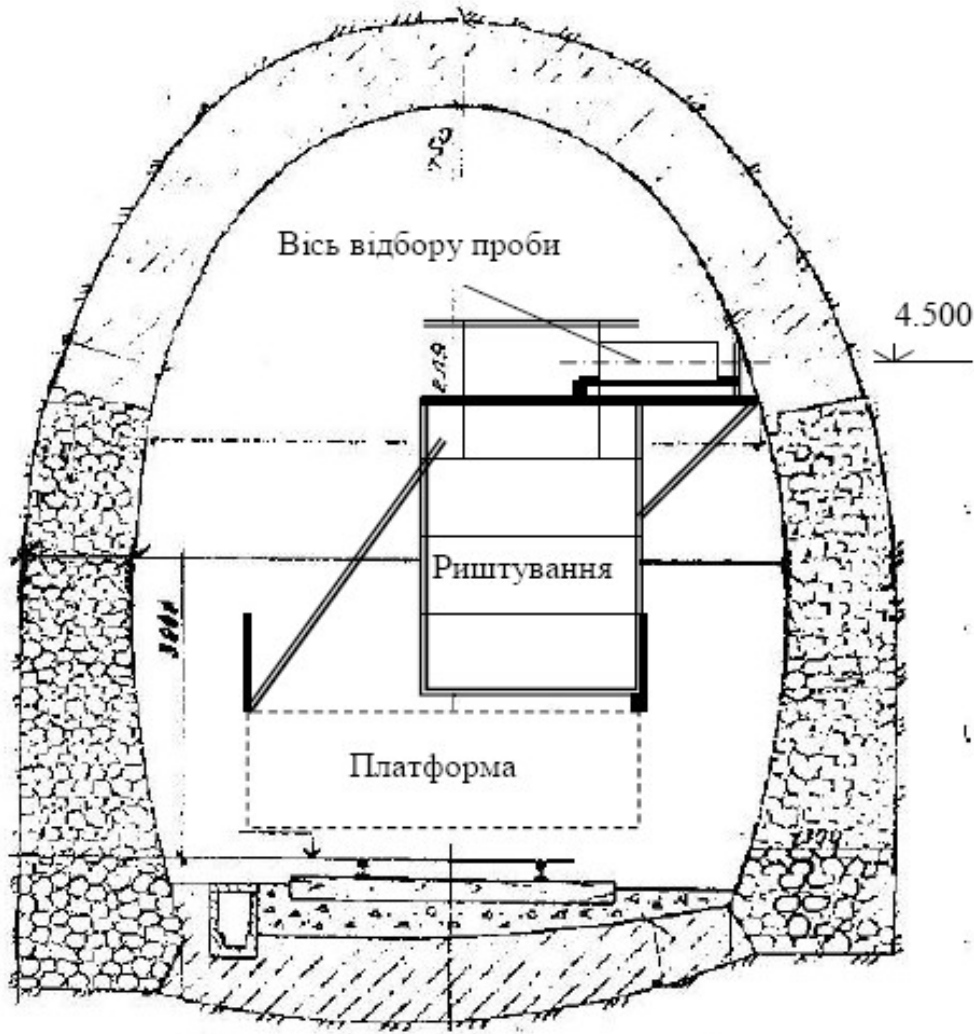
Схема відбору проб бетону з бетонного склепіння залізничного тунелю
